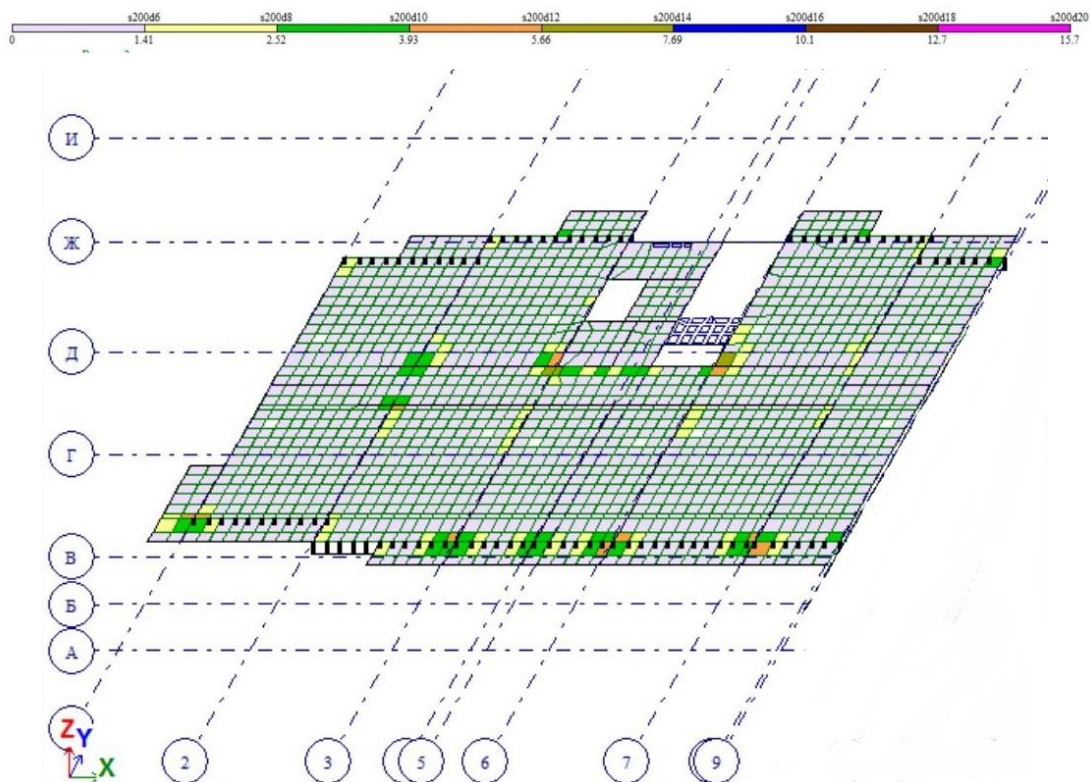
Секция 1. Верхняя арматура в плите перекрытия типового этажа по оси У см²/пм
